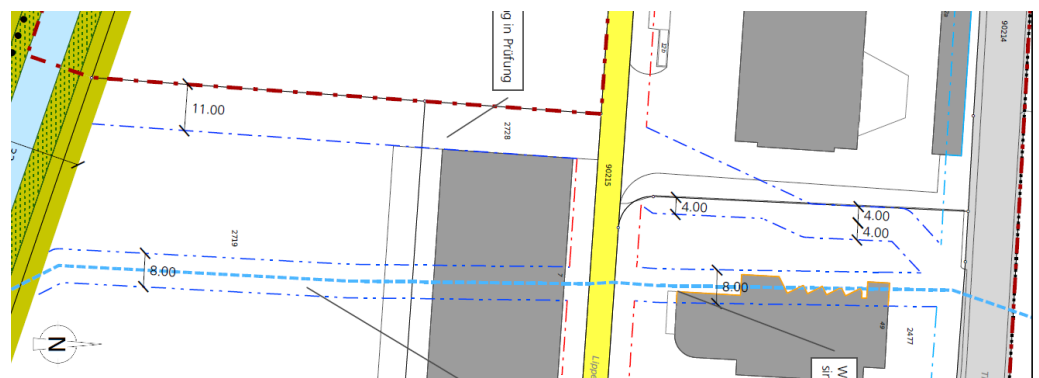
Situation Erschliessungsplan rechtsgültig (RRB Nr. 2024/460)
